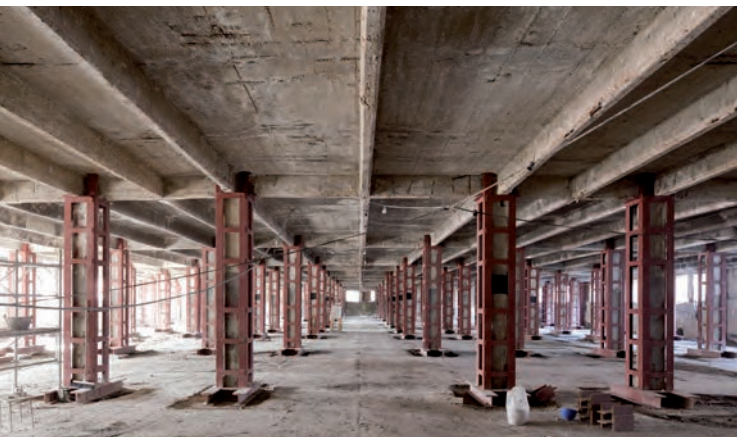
\_Interior de las naves 8 y 9, refuerzo estructural. Imagenes cedidas por el autor Arturo Franco.
